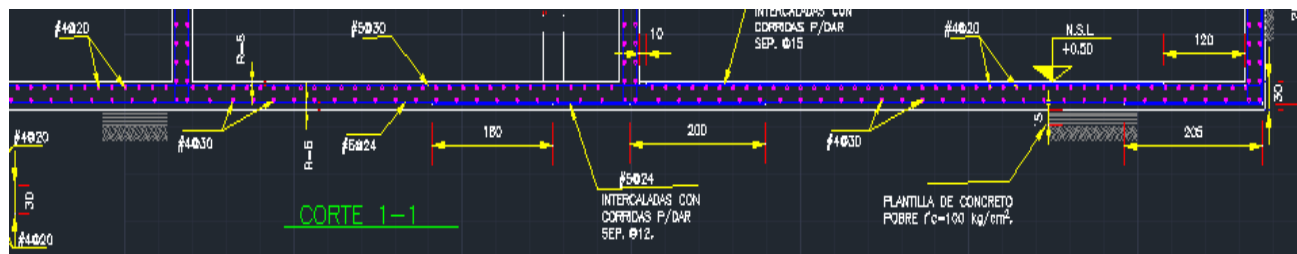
Armado de la losa fondo del cuarto de máquinas
